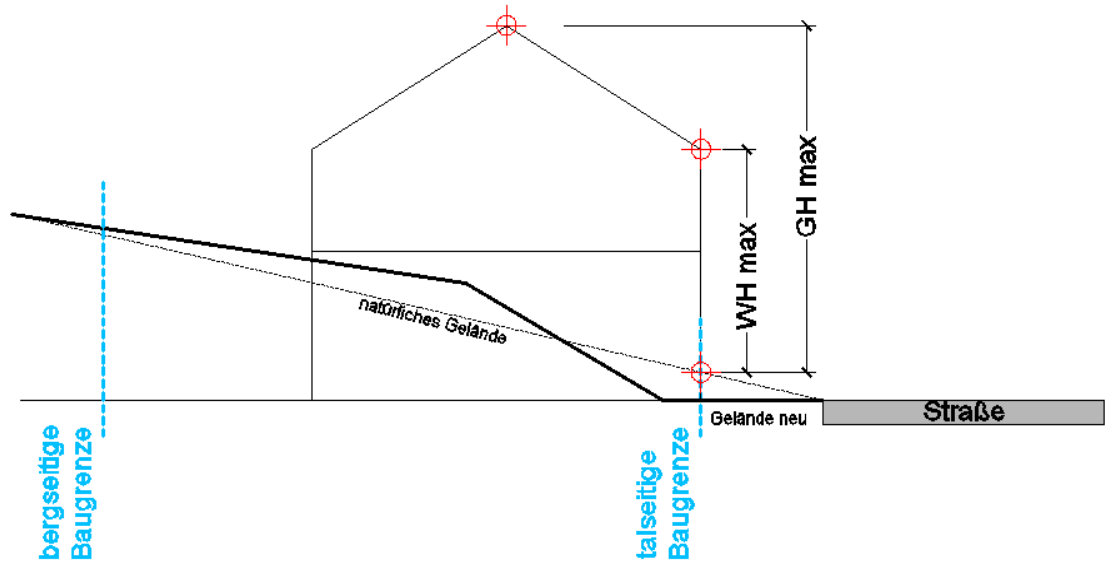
Erläuterungsskizze zweiseitig geneigtes Dach (Satteldach und Walmdach)
